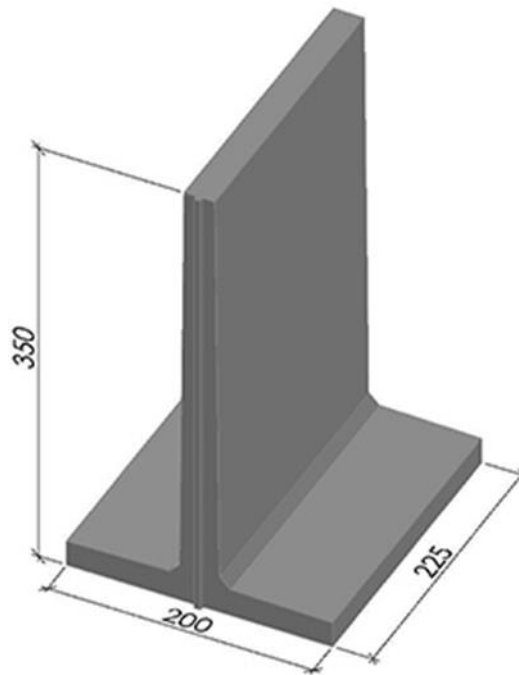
Muro de contención prefabricado GRUPO RODIÑAS o similar
